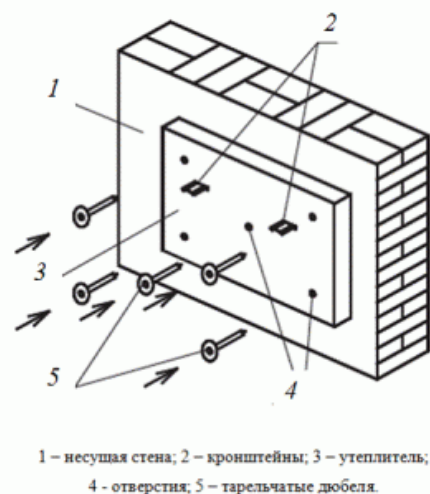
Монтаж кронштейнов на стену с прокладкой
